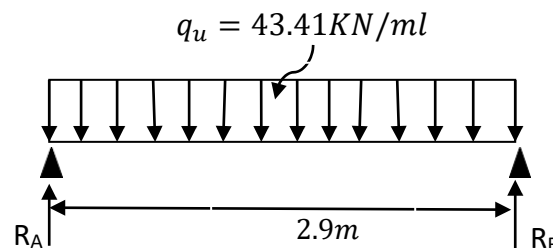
Schéma statique de la poutre palière horizontale à l'ELU.
